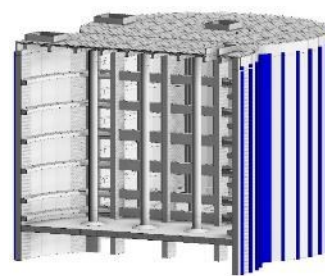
Corte transversal da estrutura do reservatório após execução da estrutura da cobertura.
